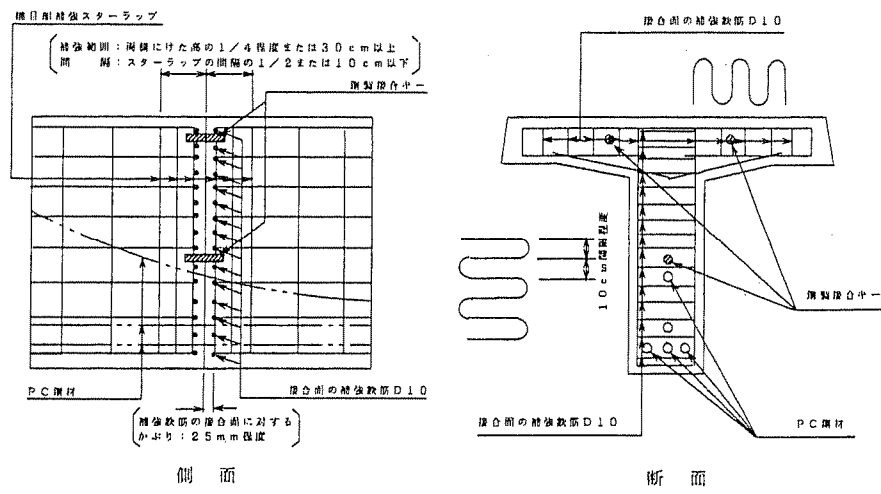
接合部における補強鉄筋の配置例 (T桁橋)
